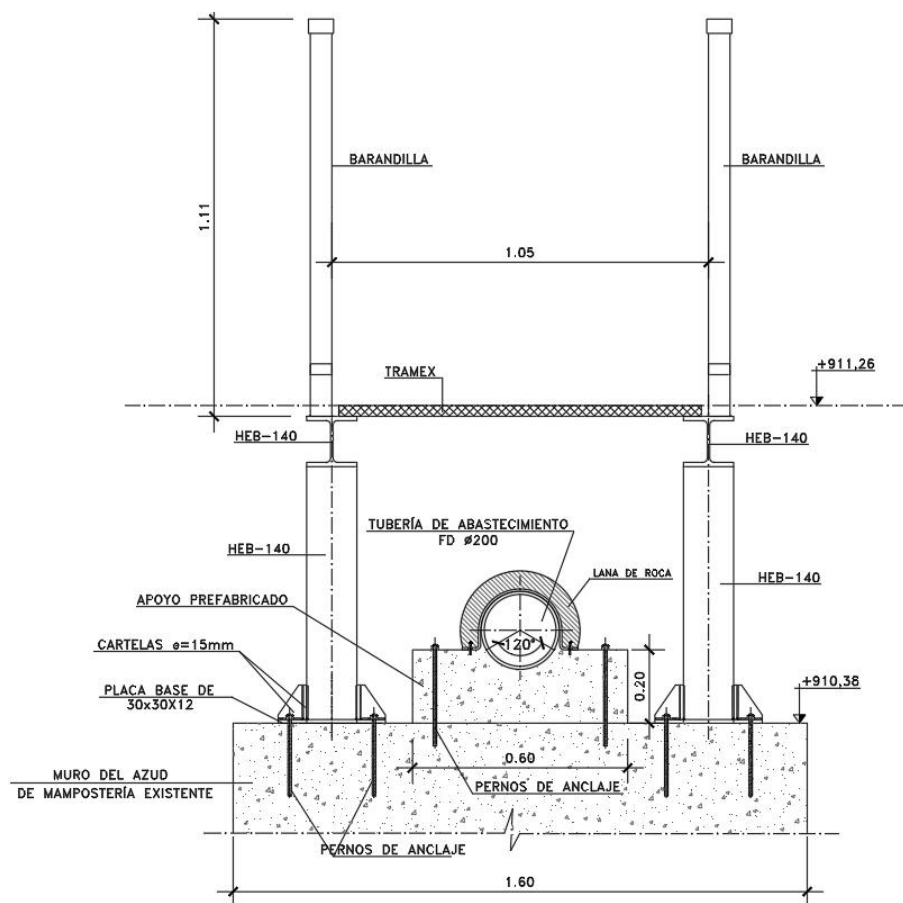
Sección transversal de barandilla y tubería sobre el azud
